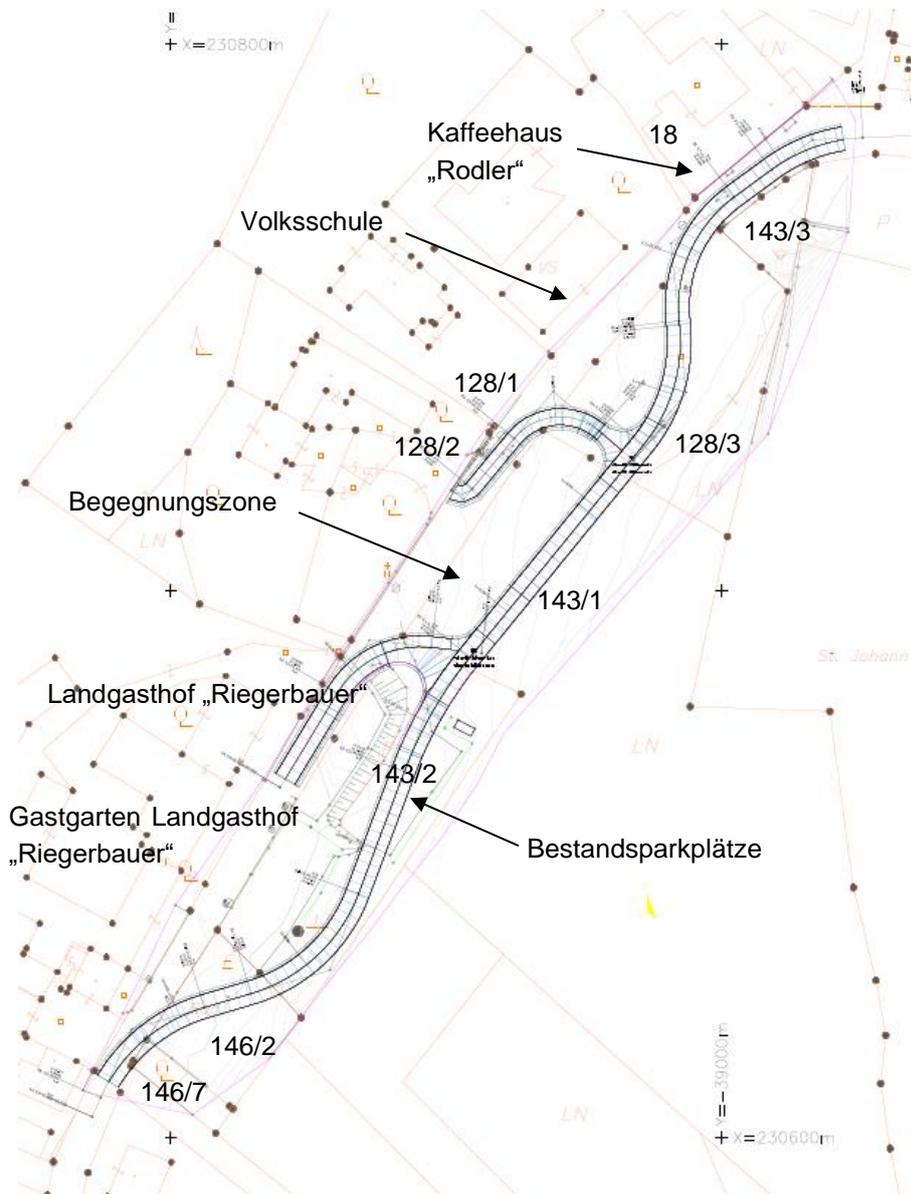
Grundriss Variante 1²²⁶
